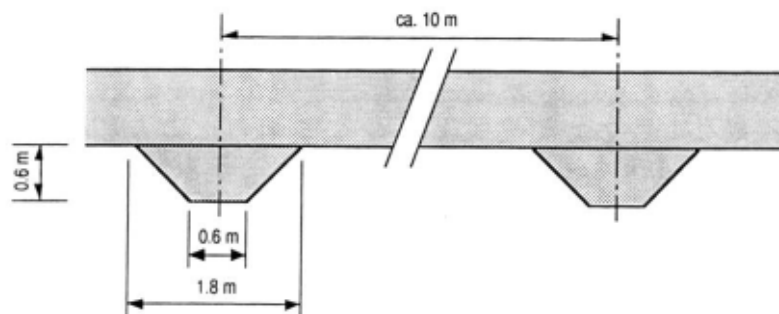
Grundrissanordnung der Rauigkeitsrippen.
